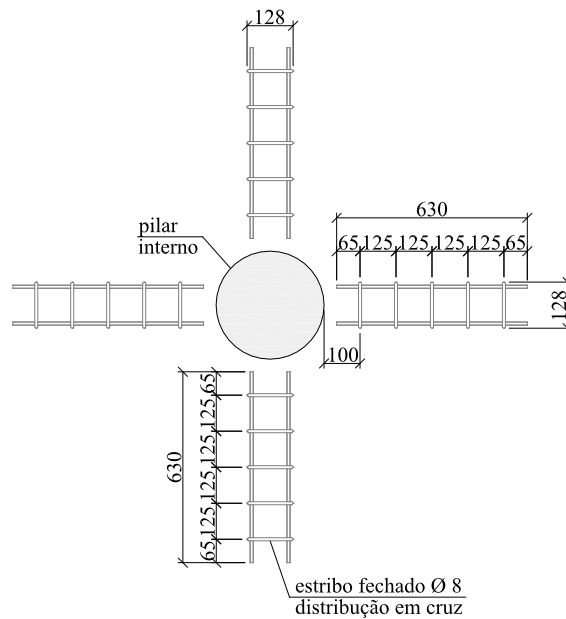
Detalhe em planta das armaduras de cisalhamento das lajes SS1 e SS2 (cotas em mm)
